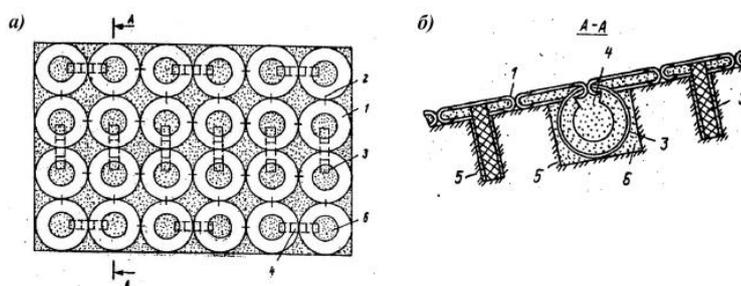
Покрытие откосов грунтовых сооружений (а.с. СССР № 1260432): а) вид в плане; б) поперечный разрез А-А
